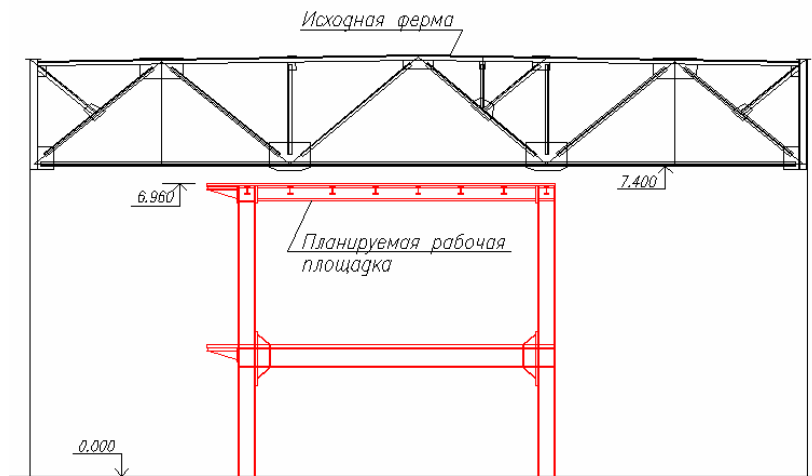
Существующие конструкции ферм и планируемая рабочая площадка
